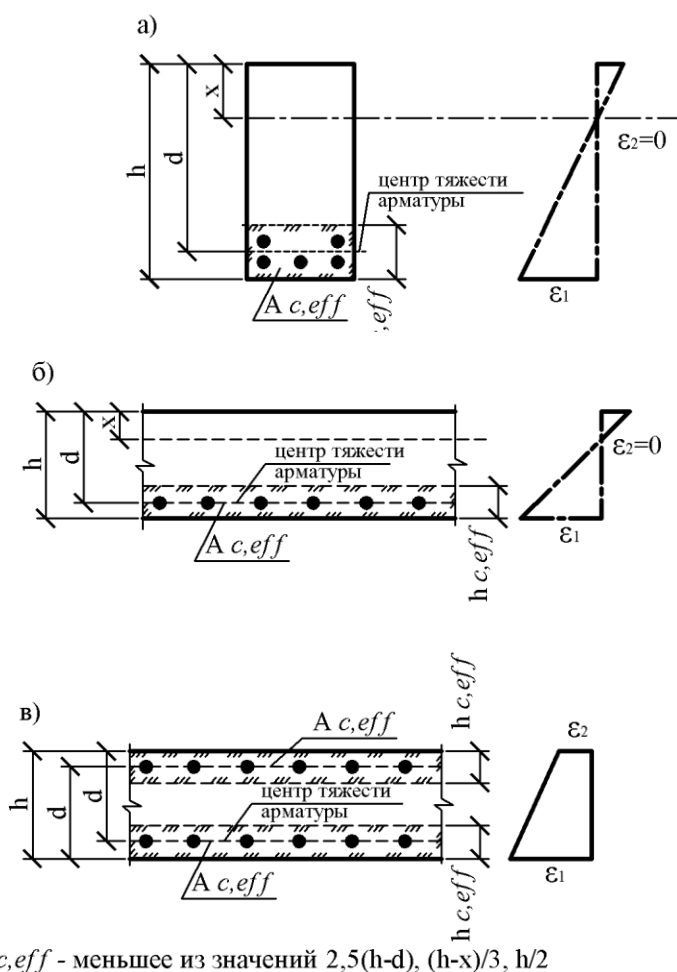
К определению эффективной площади растянутой зоны сечения $A_{c,eff}$:
